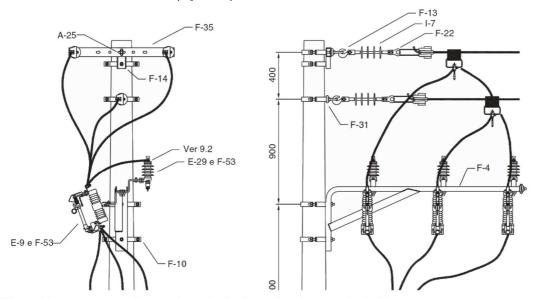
Estrutura CE2 TR (1º nível) - Poste de concreto de seção DT ou de madeira
